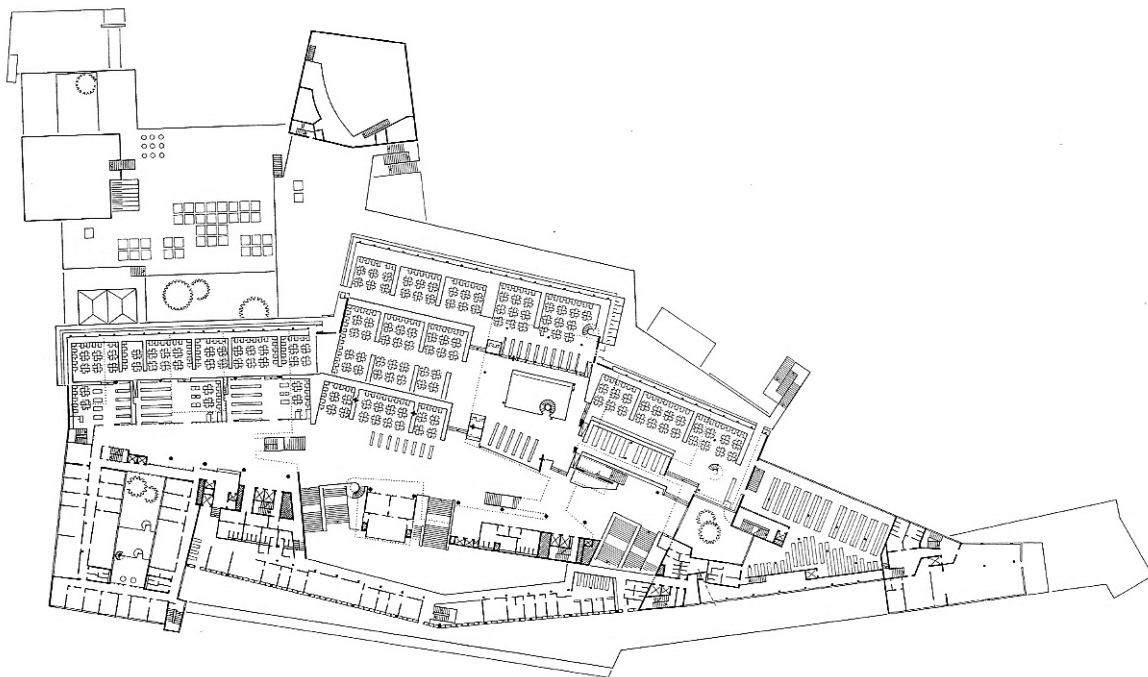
Planta da Biblioteca Nacional Alemã, de Hans Scharoun
